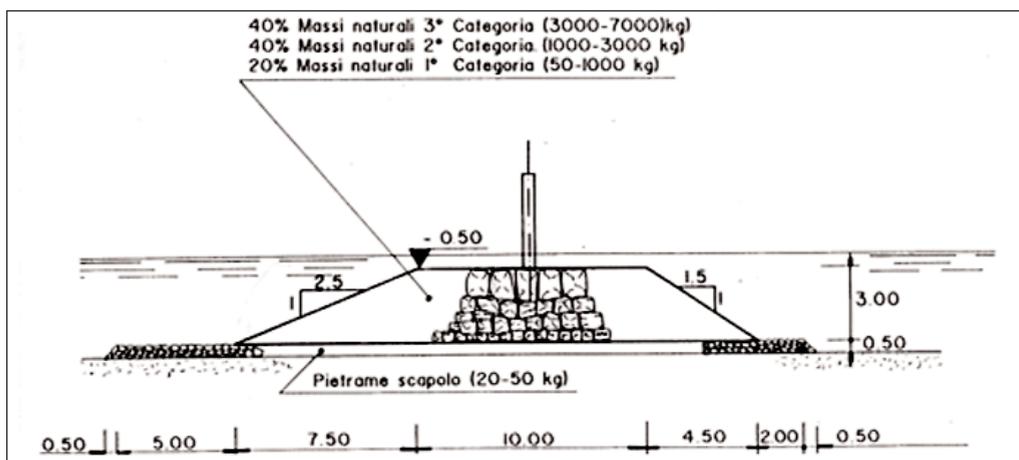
Sezione tipo della diga distanziata sommersa a Monte Marciano (AN).
